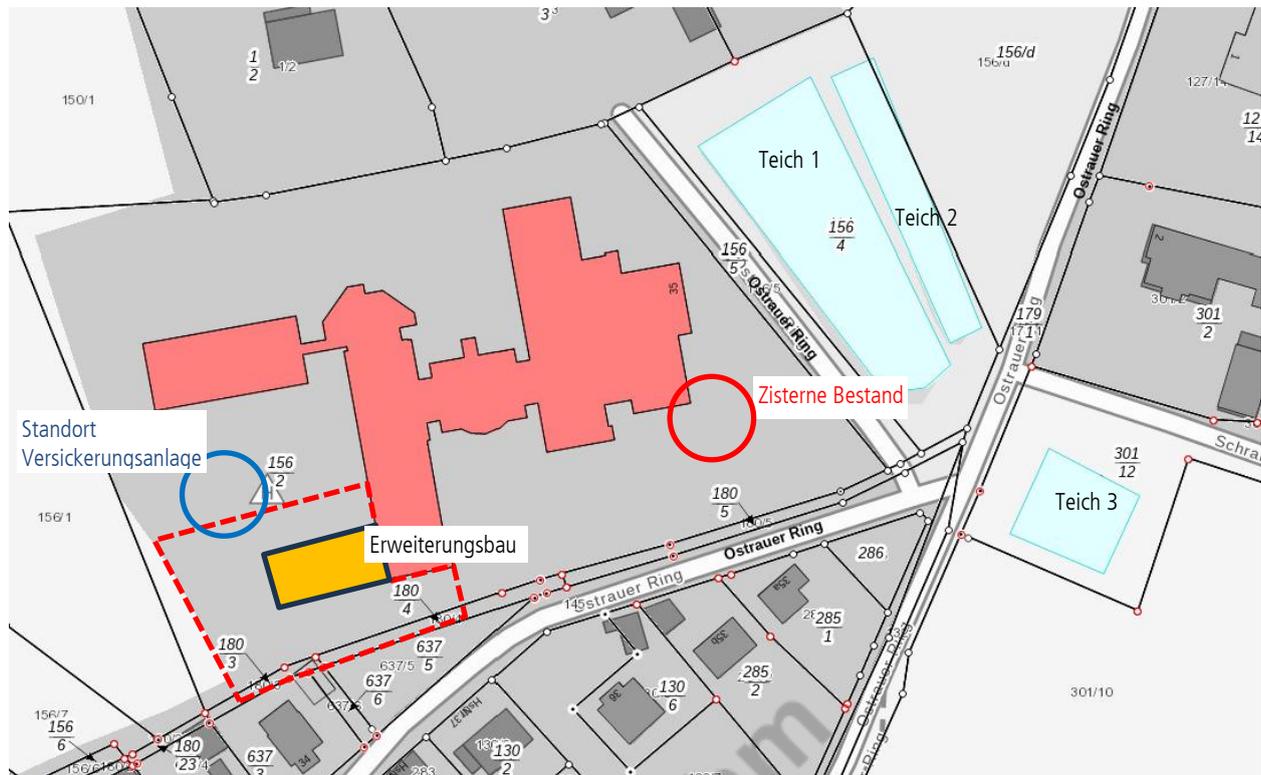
Übersicht über Lage der bestehenden Zisterne und der geplanten Zisterne / Sickerschacht sowie Lage der Löschwasserteiche
